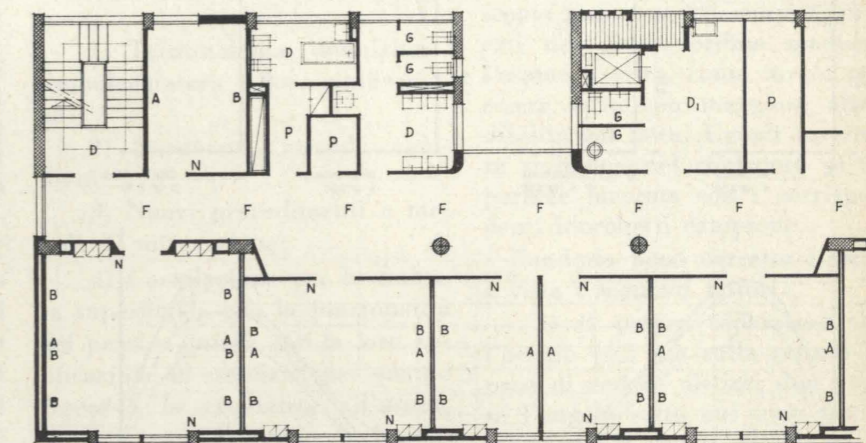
Serie di piante con indicazione del tipo delle lampade.
